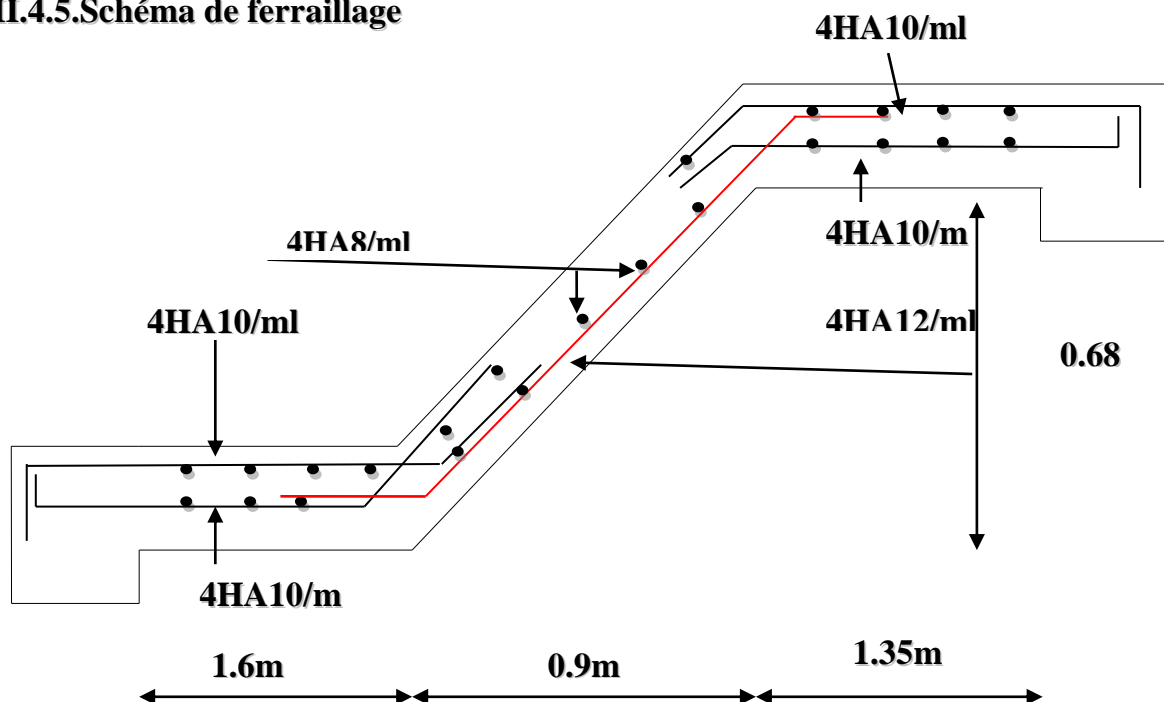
Schéma de ferrailage de l'escalier la partie AD =GJ.
